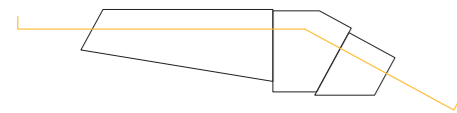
Grundriss Ebene 2\_M1:250
